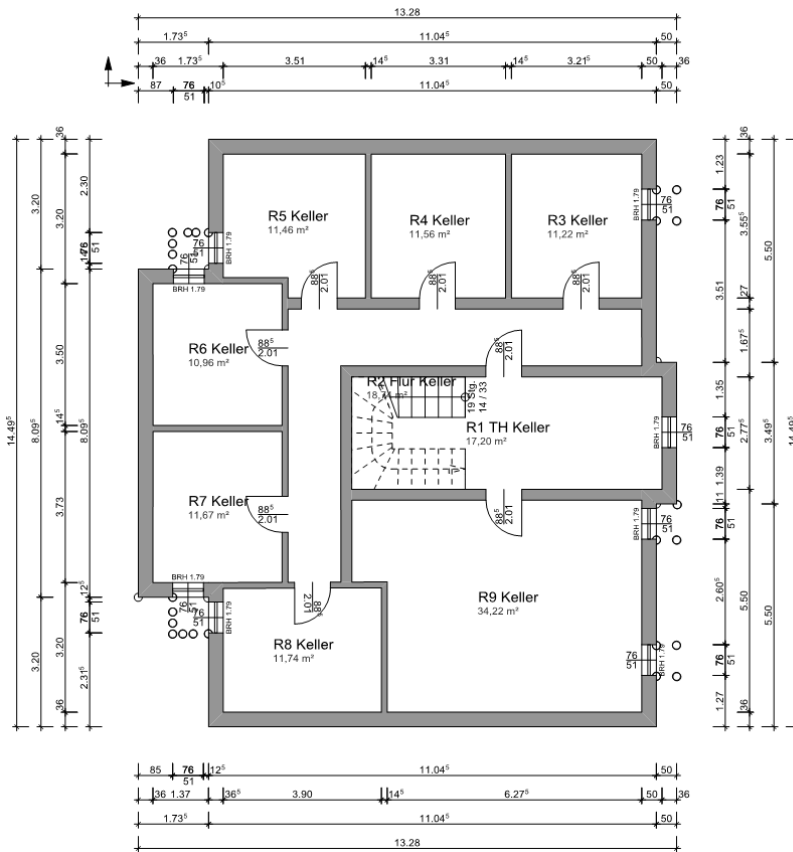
Grundriss Kellergeschoss Mehrfamilienhaus
